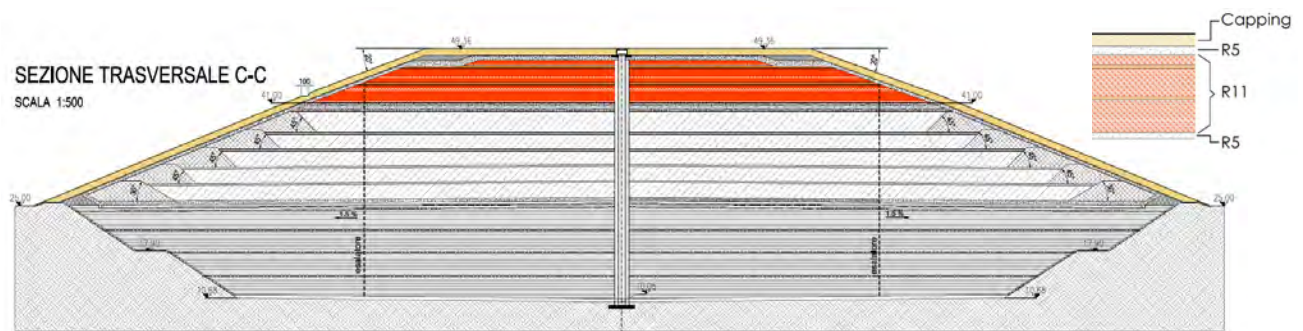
Stralcio elaborato PLANIMETRIA GENERALE – SEZIONI del progetto
